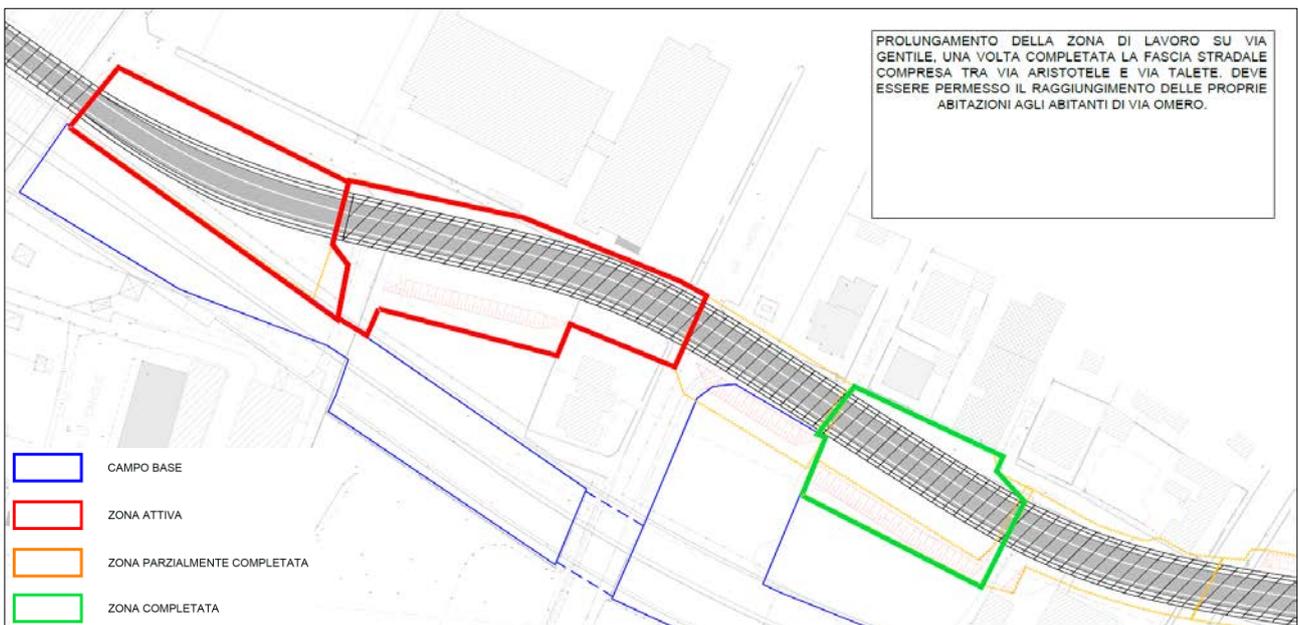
Fasi realizzazione copertura galleria del Piano di Sicurezza di progetto illustrativo della fase B di scavo della galleria.
